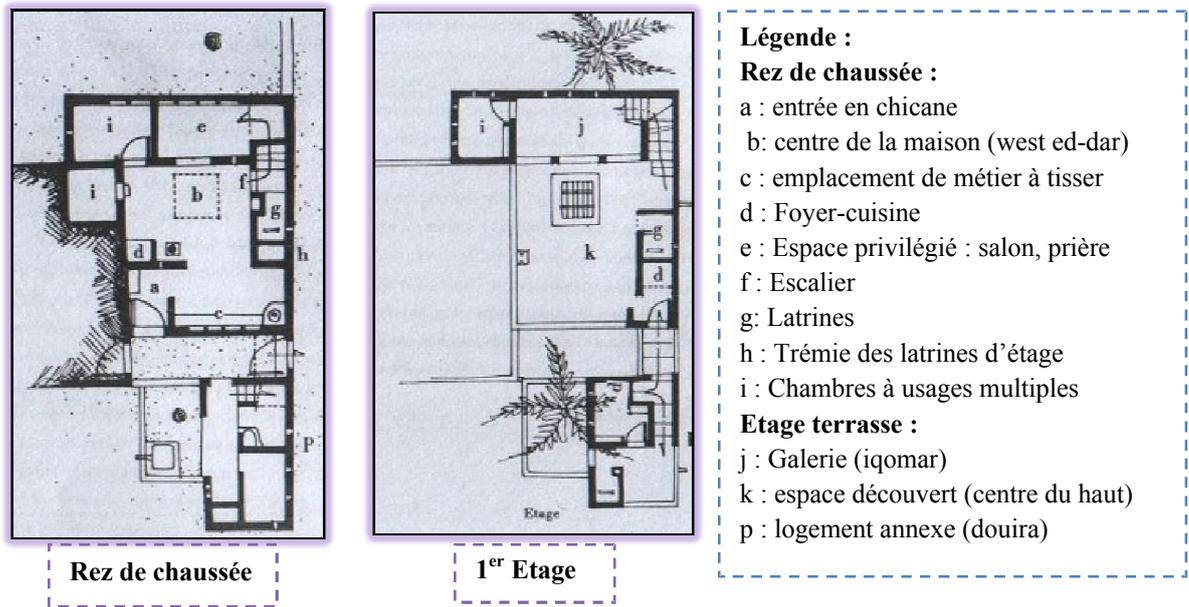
Plan d'une maison du M'Zab (palmeraie)
